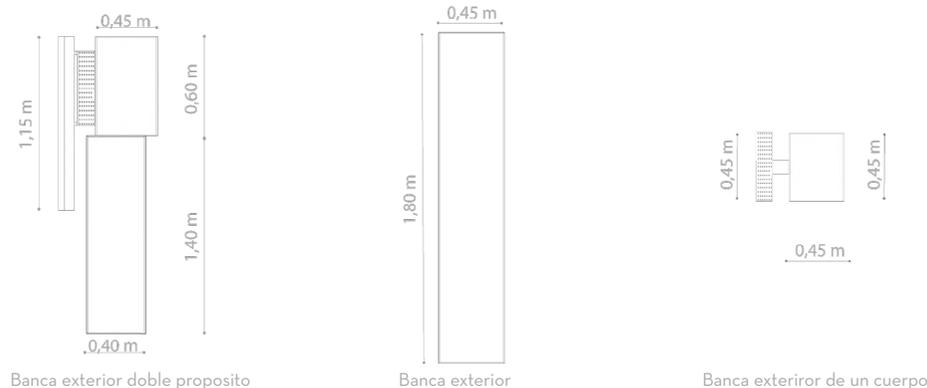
Representación en planta de bancas exteriores. Diseño de los autores. Fuente: Los autores
